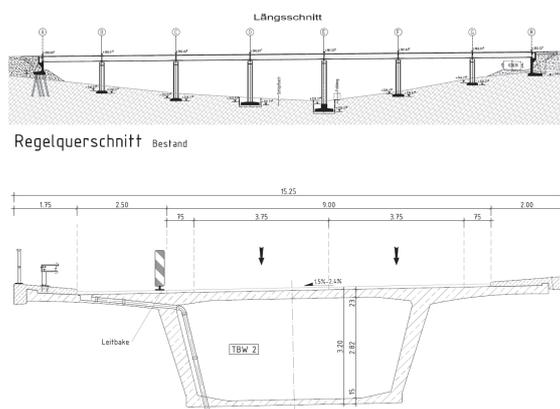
Brücke mit Längsschnitt und halbem Regelquerschnitt (TBW 2)
